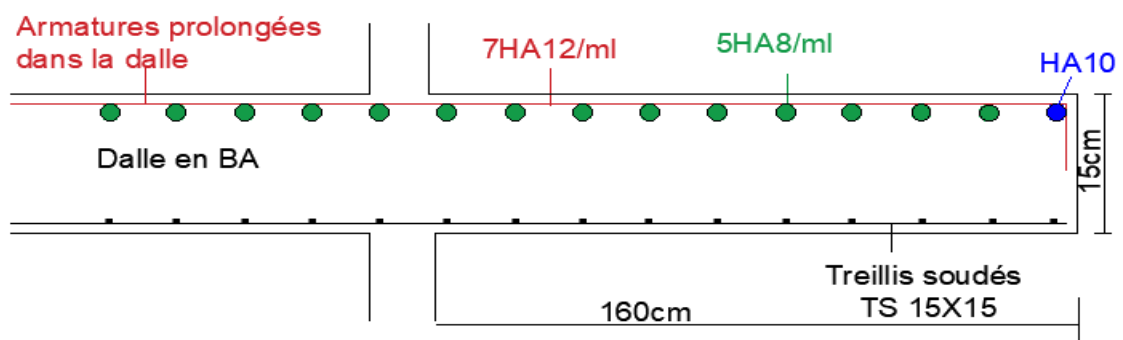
Coupe du ferrailage du balcon selon le CBA 93.
